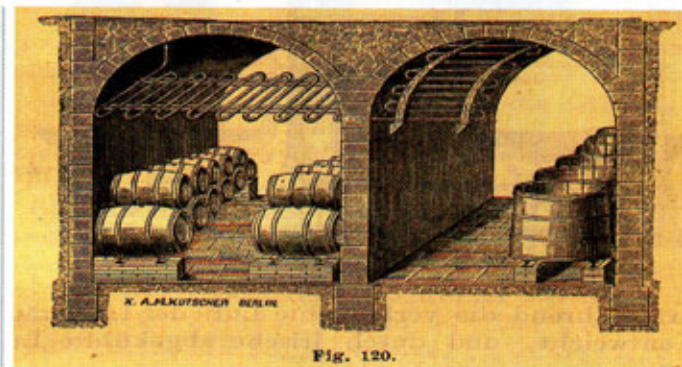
Rückschau auf ein Jahrhundert Technik: Bierkühlung
